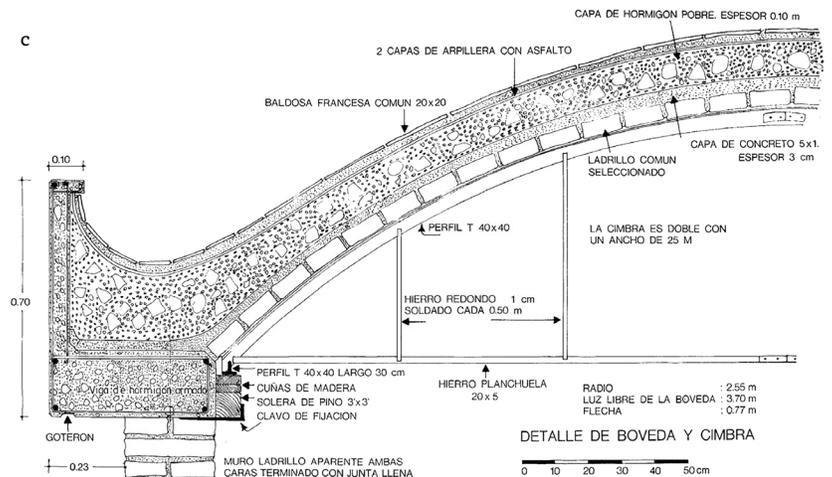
Bóveda cilíndrica sobre cuadrado o rectángulo, con estribo en los muros laterales y tirante oculto en los muros de testa. El estribo trabaja como una viga apoyada con carga uniforme, que es el empuje de la bóveda.
